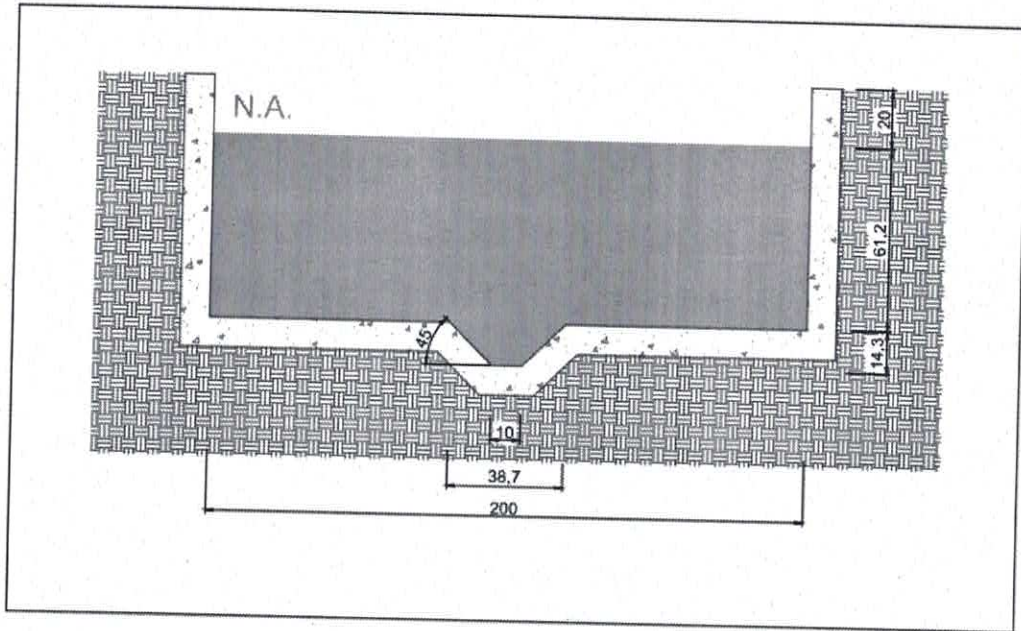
Corte transversal do canal retangular revestido em pedra argamassada (medidas em cm)
